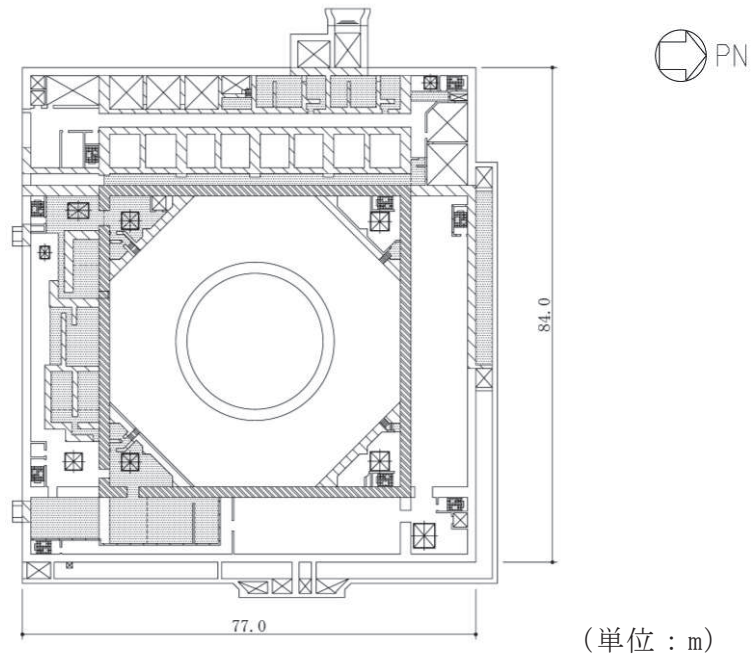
(2) 原子炉建屋原子炉棟（二次格納施設）の範囲の断面図
